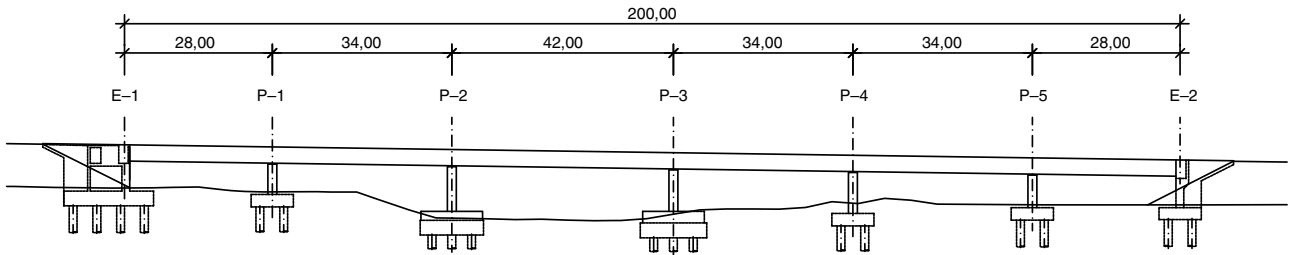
Alzado Viaducto sobre Barranco del Boch.
